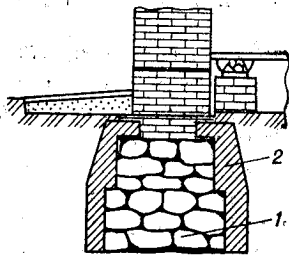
Посилення існуючого фундаменту та збільшення ширини його підшови за рахунок утворення залізобетонної обойми:
